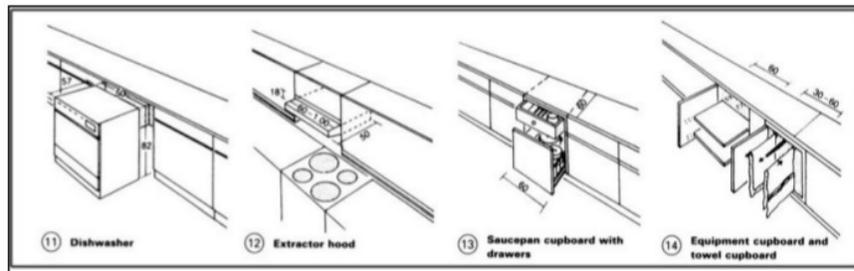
Besaran Ruang Dapur Dan Toilet
